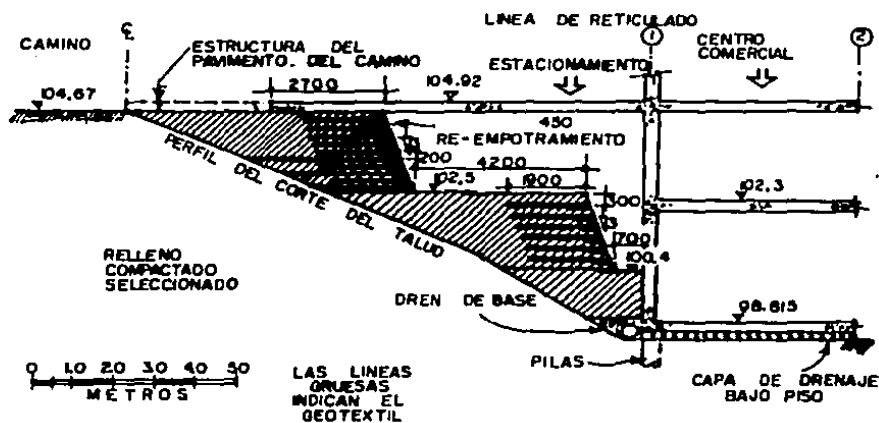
ESTADO DE LA CONSTRUCCION FINAL (REF. No. 90)
